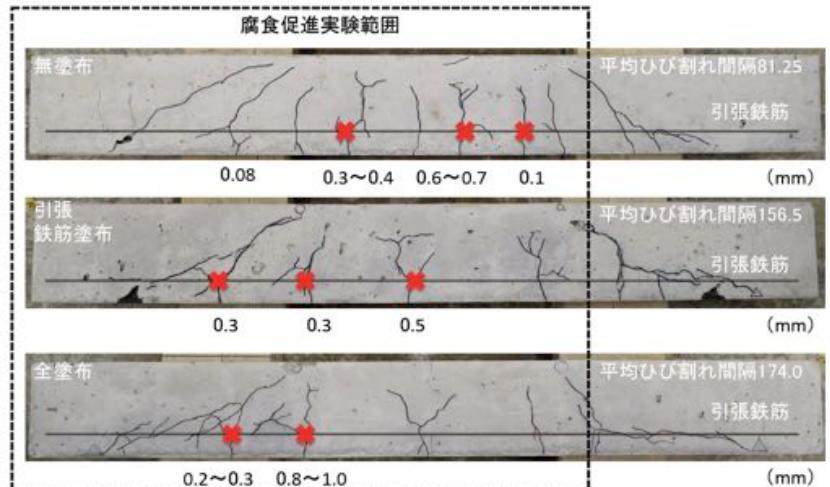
ひび割れ発生後の鉄筋腐食の影響
